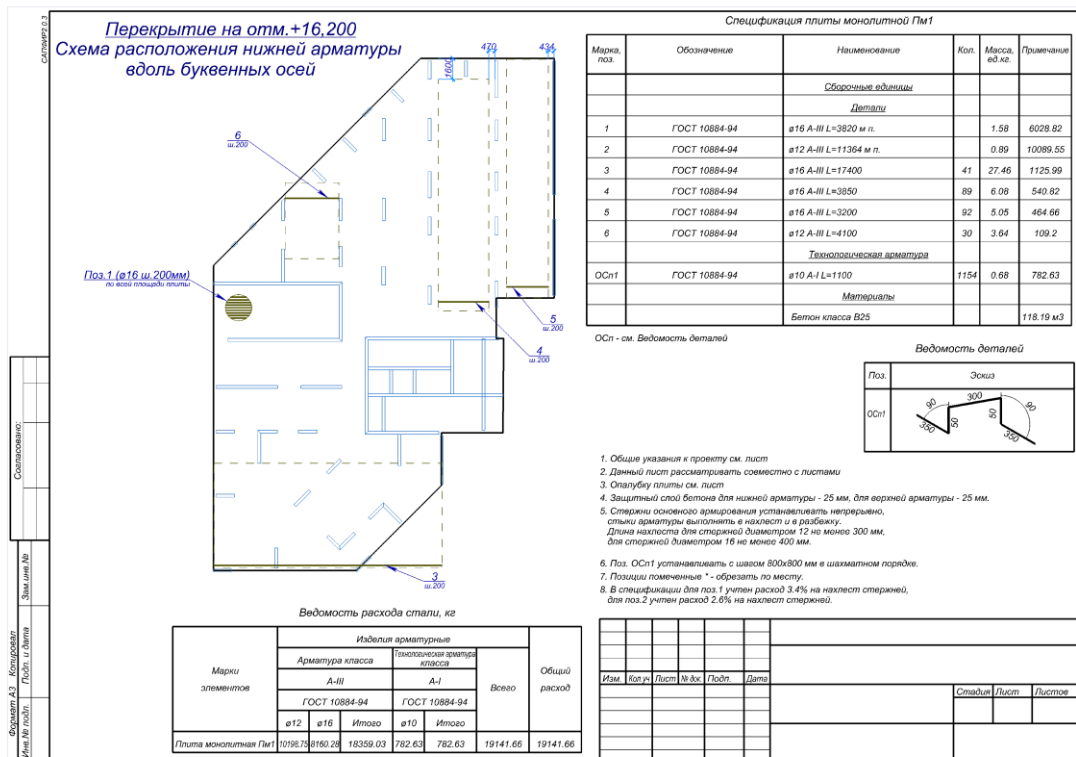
Лист чертежа схемы продольного армирования плиты перекрытия с автоматически созданными таблицами
